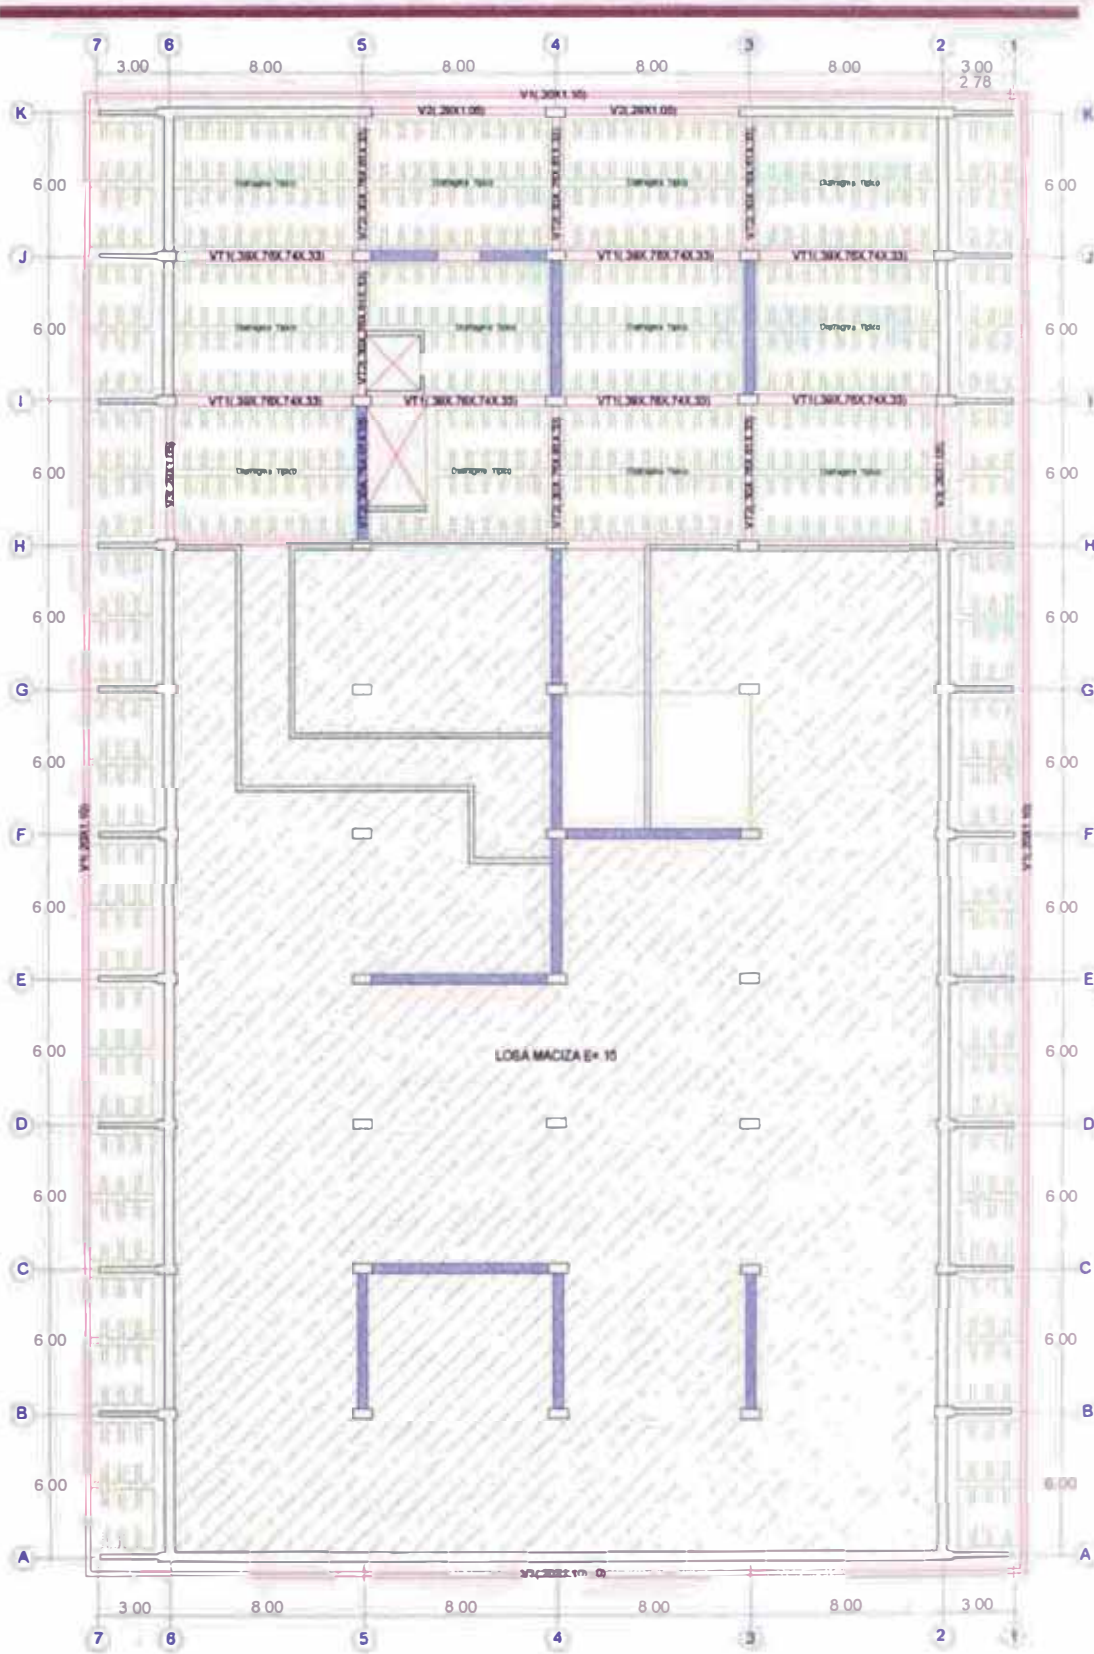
Vista en planta de losa de techo del primer piso.
